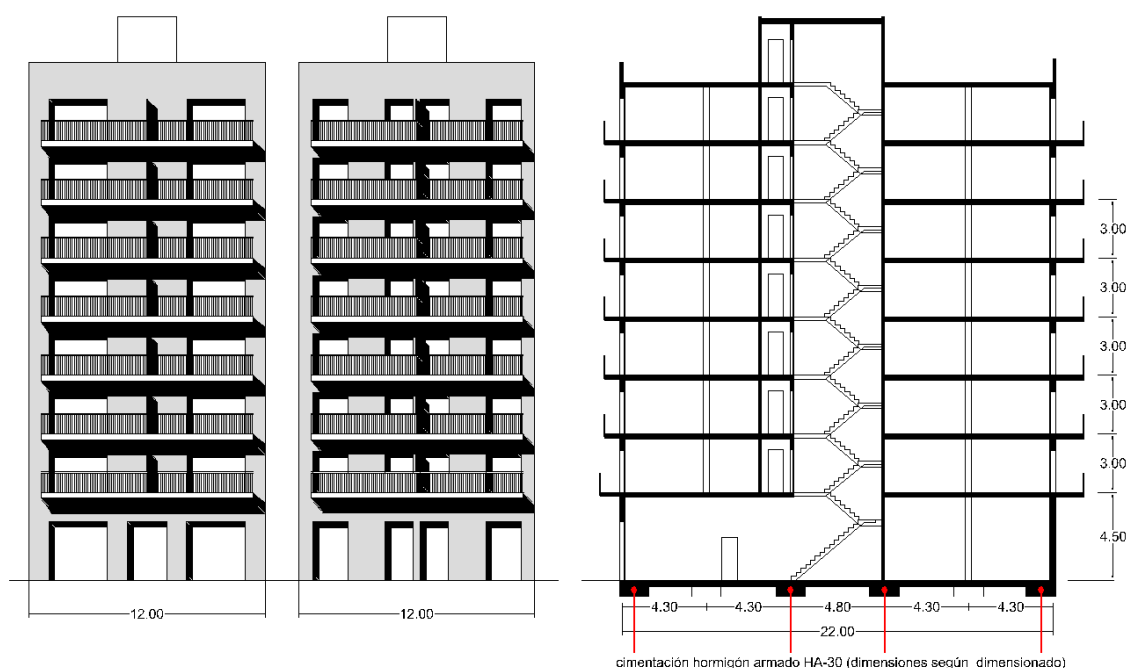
i Plantas, alzado y sección del modelo III.7
